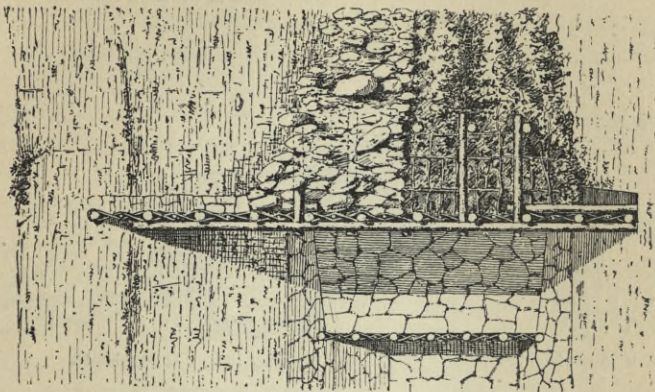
Holzsperrre, 2 m hoch. c Daraufrsicht.
